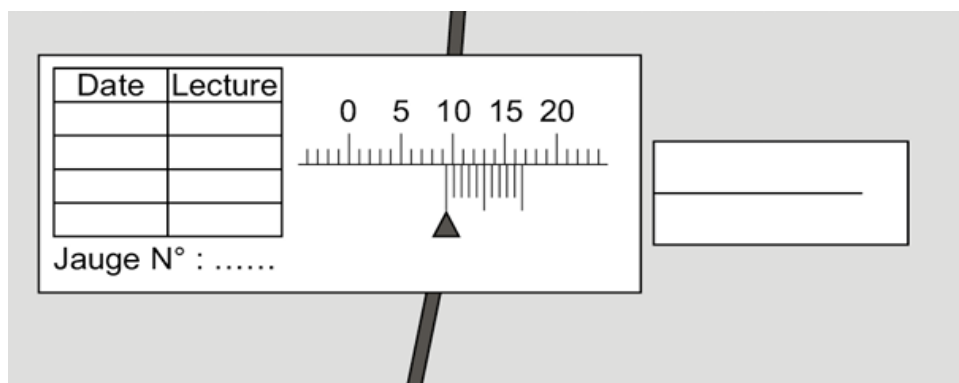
Jauge de mesure de fissure dans un même plan [23]
